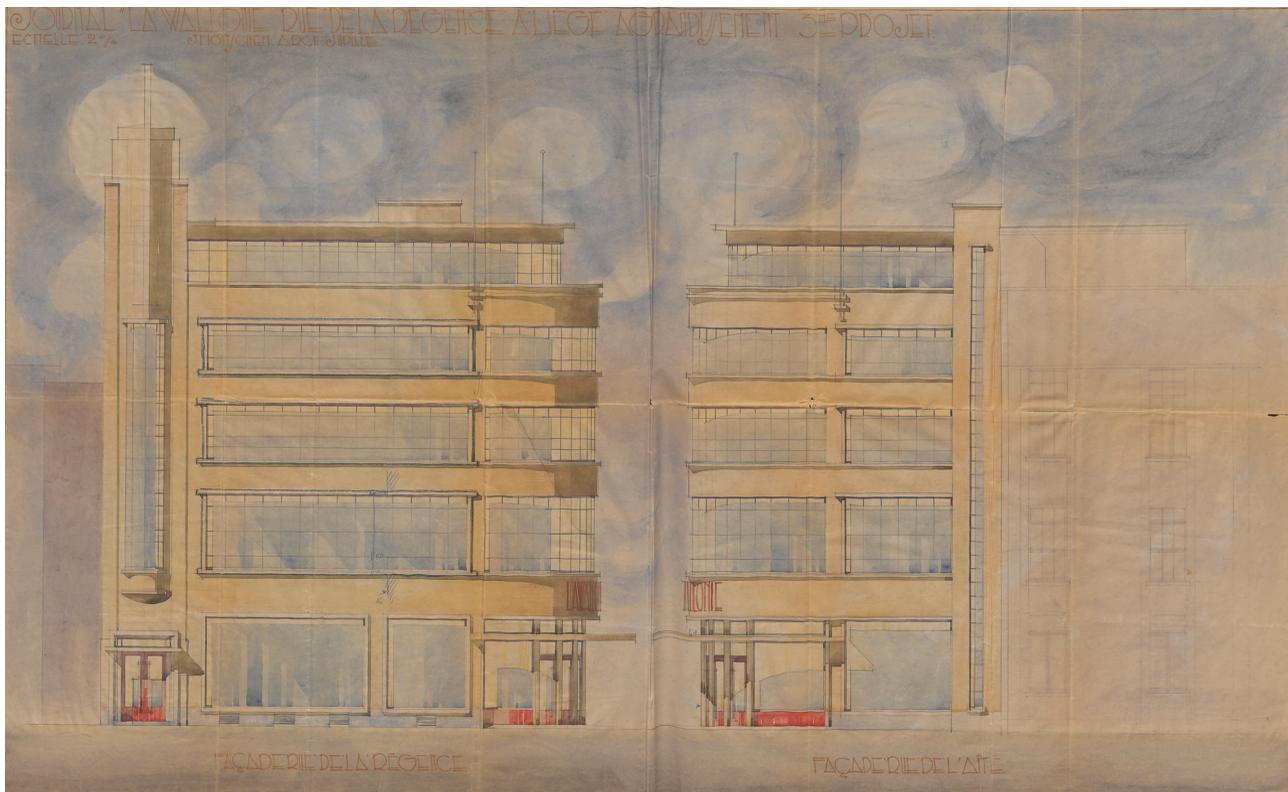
Joseph Moutschen, projet d'agrandissement des installations du journal La Wallonie, élévations de la façade.
